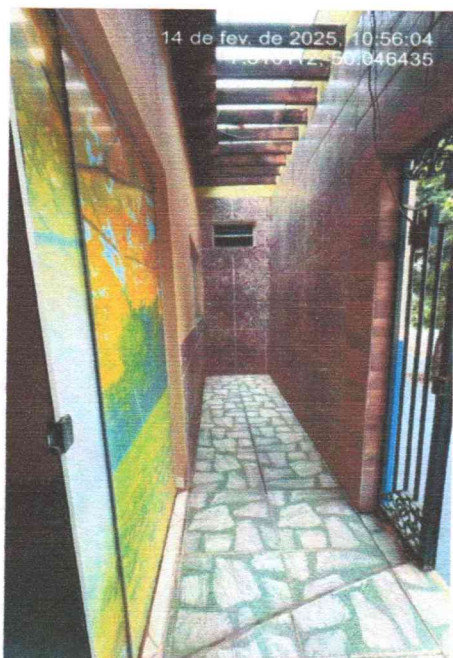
Acesso Principal: Vista para Wc 04 e Wc 03
